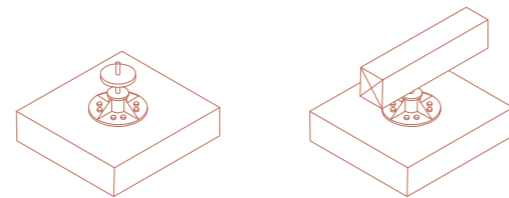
Elementi di fondazione con plinti prefabbricati
